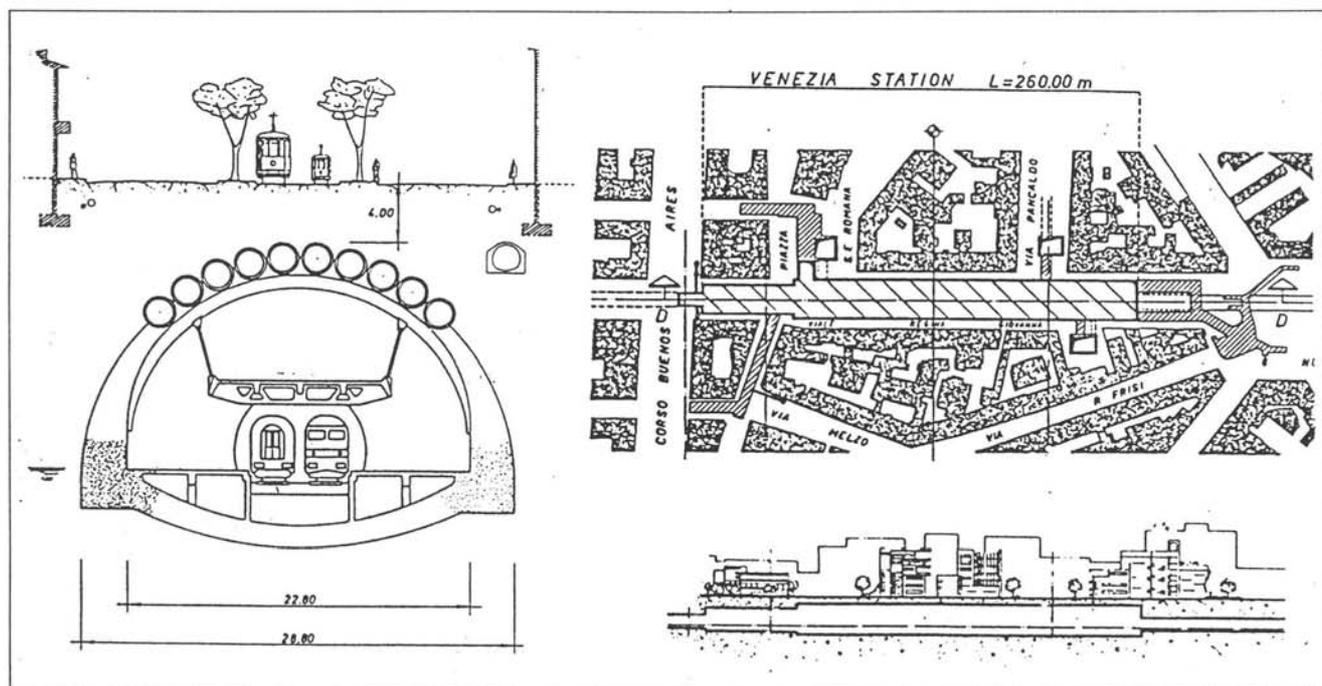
Stazione Venezia: sezione trasversale, planimetria e profilo longitudinale. Venezia station: cross section, plan and longitudinal profile.
